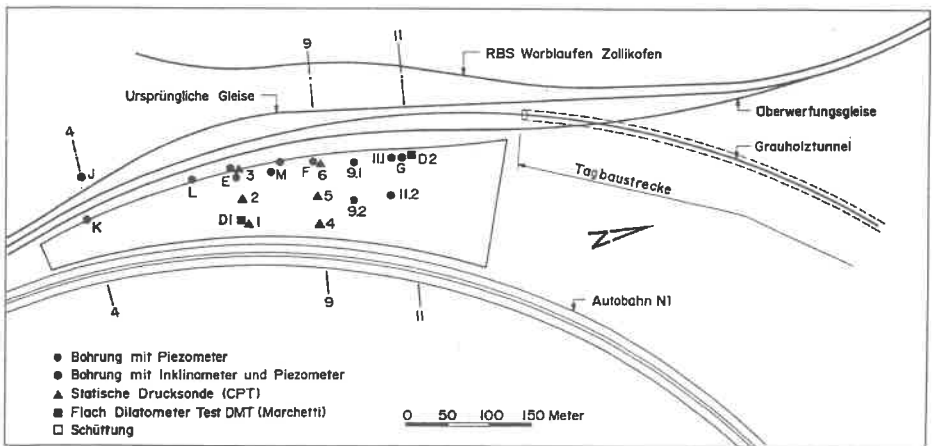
Lageplan der Schüttung Ittigenmösli mit Sondierungen und Instrumentierung.
